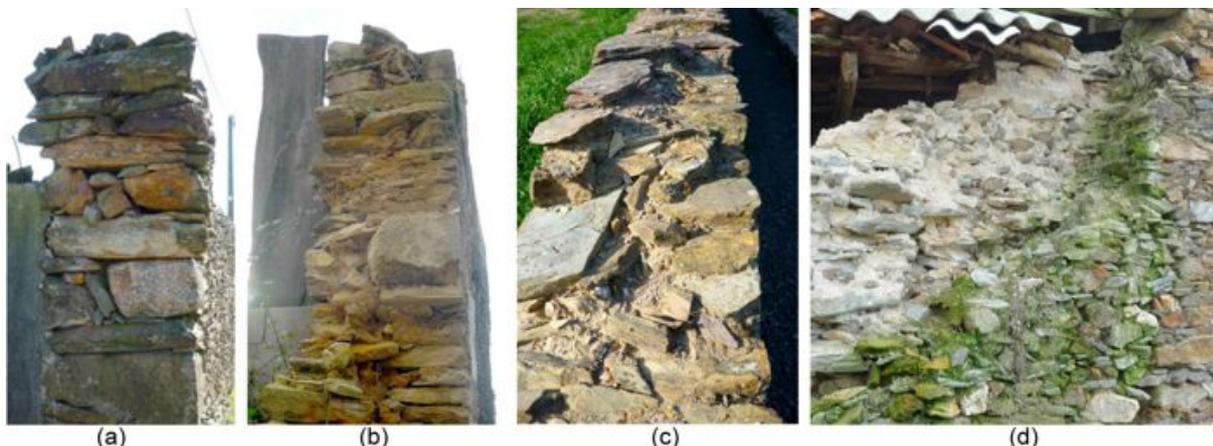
(a) Muro (2 m) com duplo paramento e travadouros (CQ); (b) Alvenaria estrutural de triplo paramento imbricado e com travadouros (VL); (c) Base de muro (3 m) com triplo paramento que se sobrepõem no núcleo (AL); (d) Alvenaria estrutural de anexo com triplo paramento com elevada rugosidade nas faces interiores (VL)
